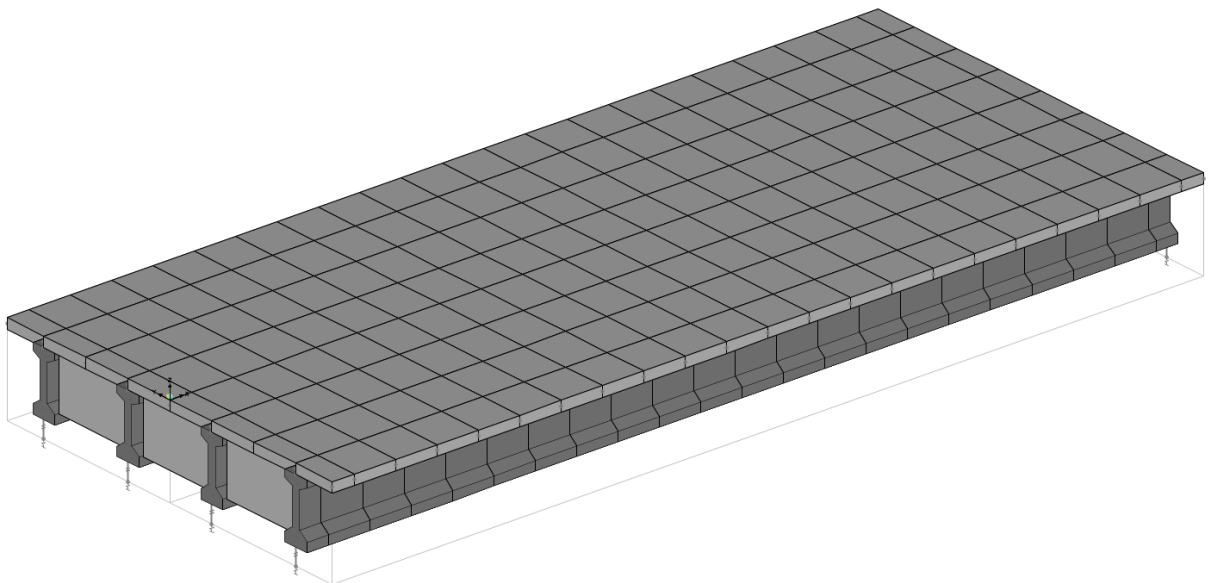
Exemplo de modelagem da laje, vigas, encontro e fundações encontrado no CSI Bridge
